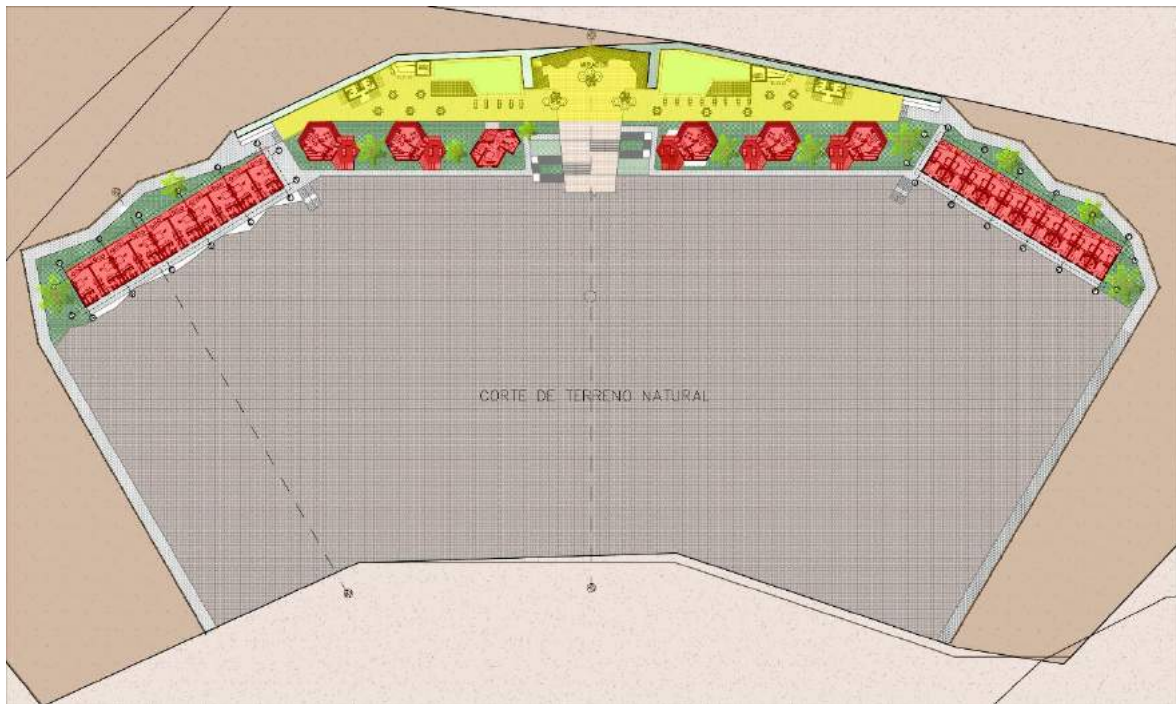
Zonificación Tercera Planta Baja (N.P.T: +21.00m)
